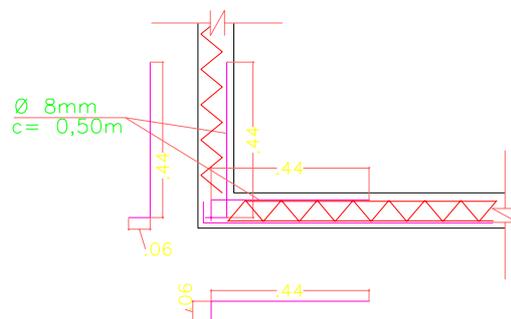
Detalhamento da armadura dos painéis Jet Casa
